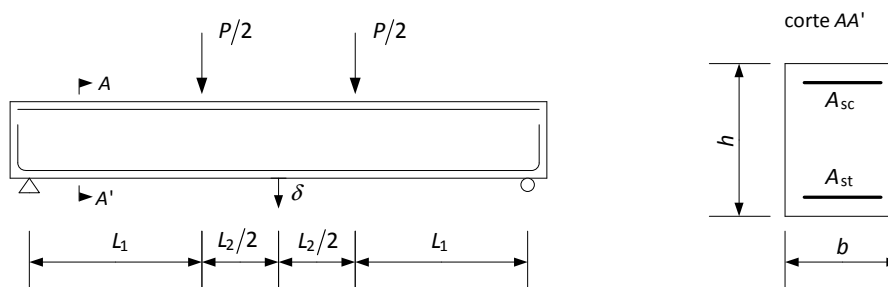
Geometria das vigas modeladas, carregamento e condições e apoio.
